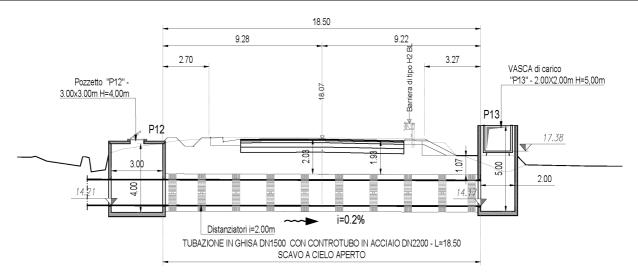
Attraversamento alla pk 0+025,00 dell'NV15 – Sezione Longitudinale
